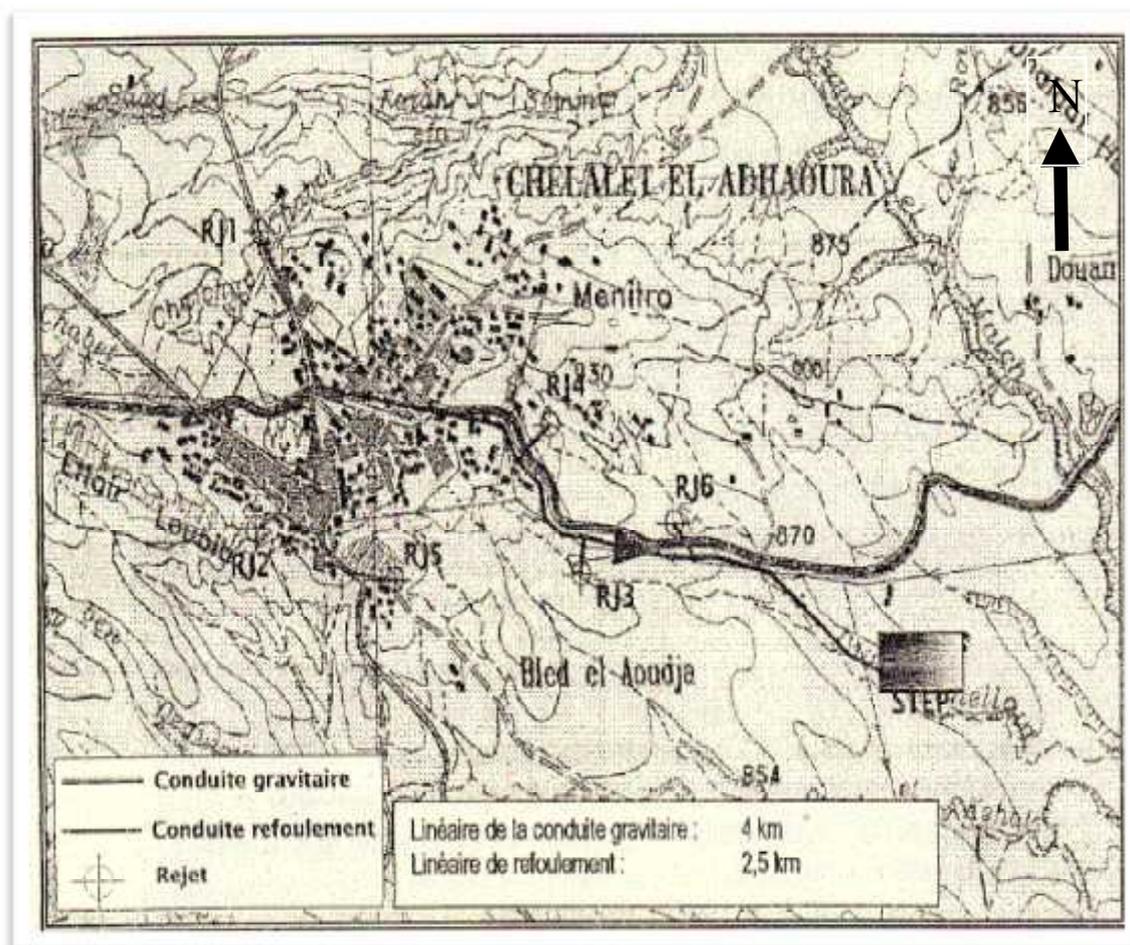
Implantation de la future STEP DE CHELLALET ELADHAOURA sur une carte topographique à l'échelle de 1/50 000 (HPO, 2009)
